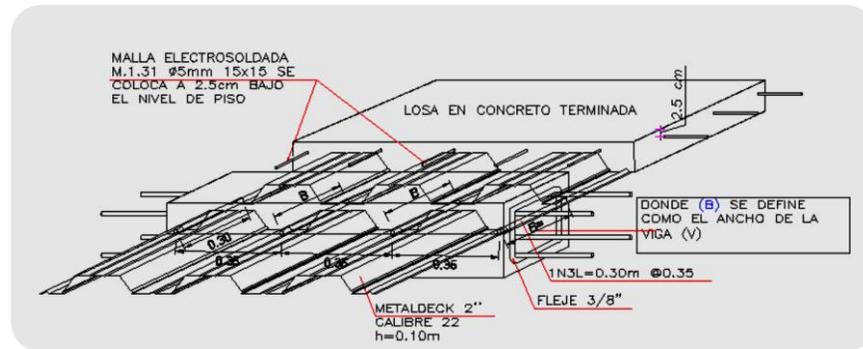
Separadores de concreto metaldeck y conectores de cortante metaldeck
